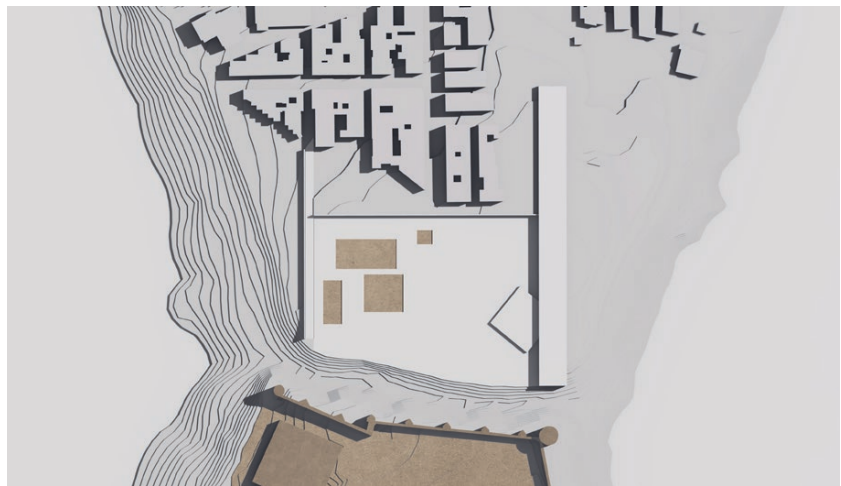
Lucera. Progetto per l'area archeologica antistante il Castello: planivolumetrico e pianta generale di progetto.
